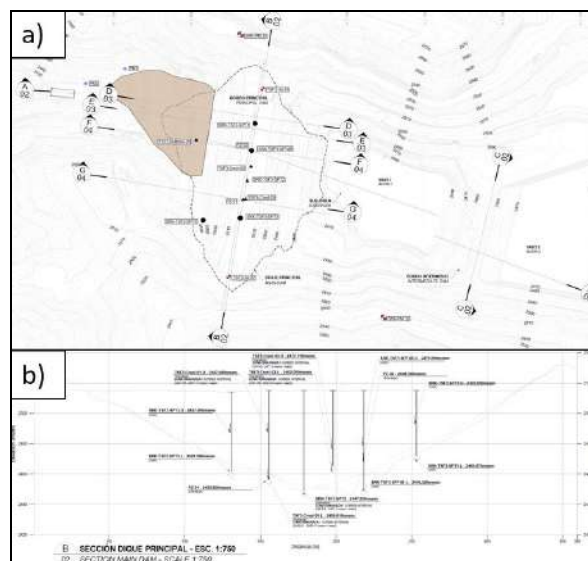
La Ciénega: (a) vista en planta y (b) elevación en bordo principal.
